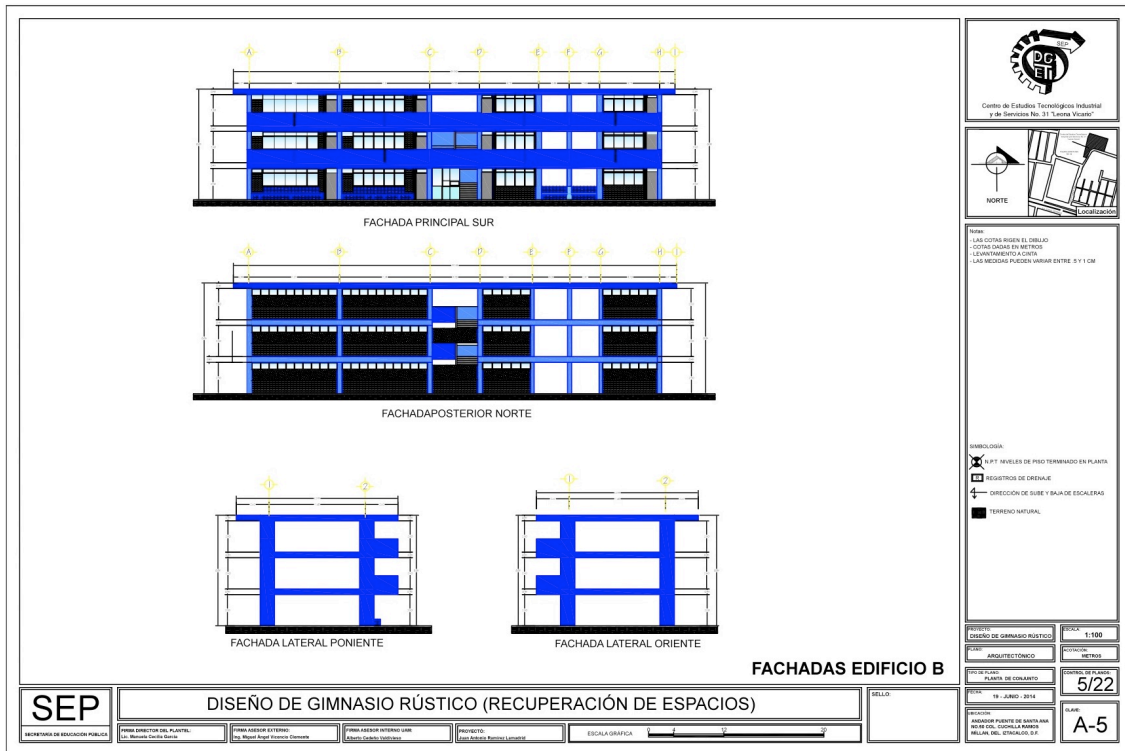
Fachadas del edificio B, levantamiento por Juan Ramírez.
